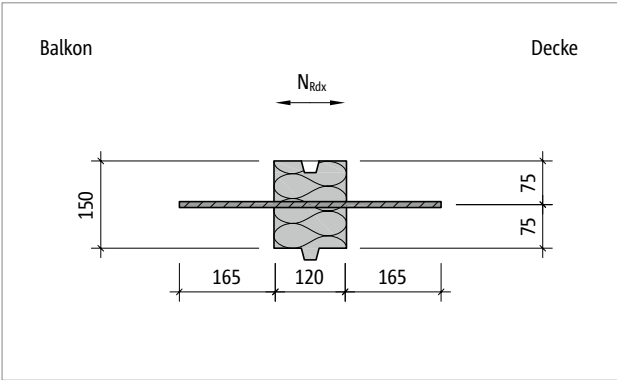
Schöck Isokorb® XT Typ H-NN1: Produktgrundriss
